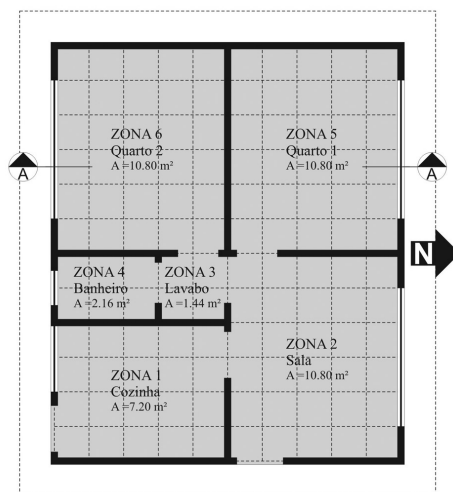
Planta baixa do modelo (malha de 600 x 600 mm).
